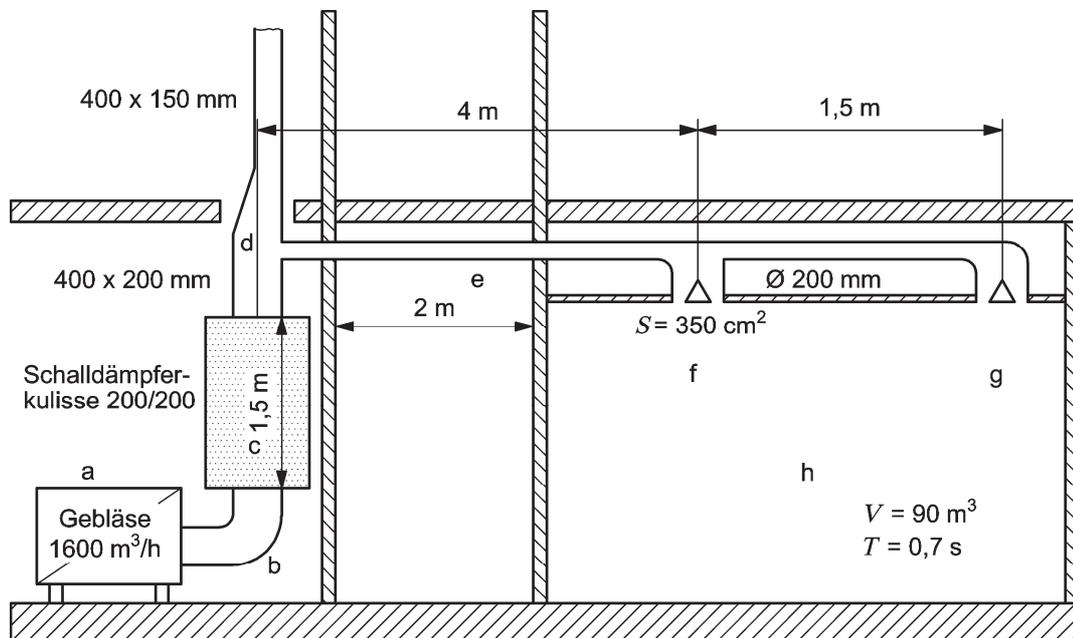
Beispiel für eine Situation mit einer Lüftungsanlage
